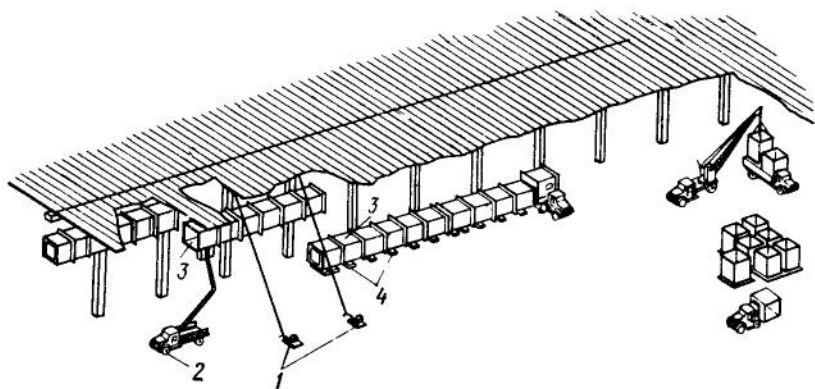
Монтаж горизонтальных воздухопроводов под перекрытием здания: 1 — лебедка, 2 — автогидроподъемник, 3 — воздухопроводы, 4 — подкладки
